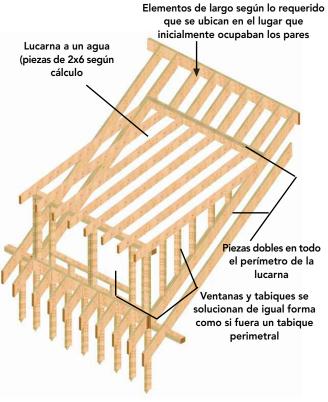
76: Lucarna a un agua que interrumpe los elementos estructurales del diafragma inclinado y que requiere de refuerzos en el perímetro donde se recortaron las piezas de la estructura de techumbre.
